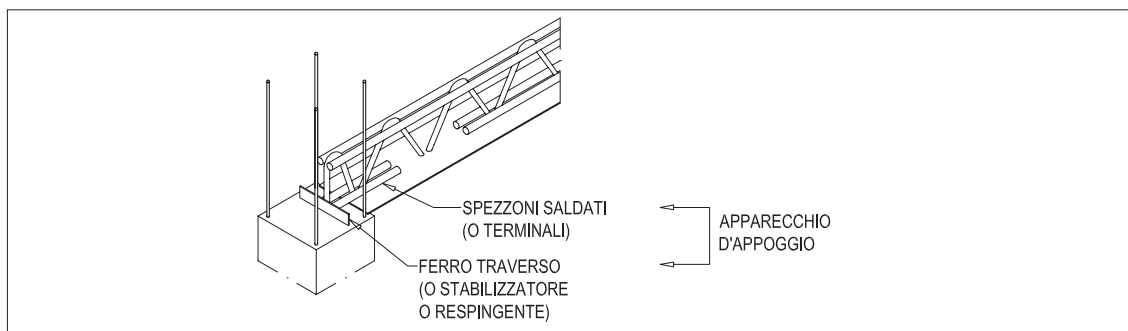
Apparecchio d'appoggio con fondello in acciaio e traverso piatto.
